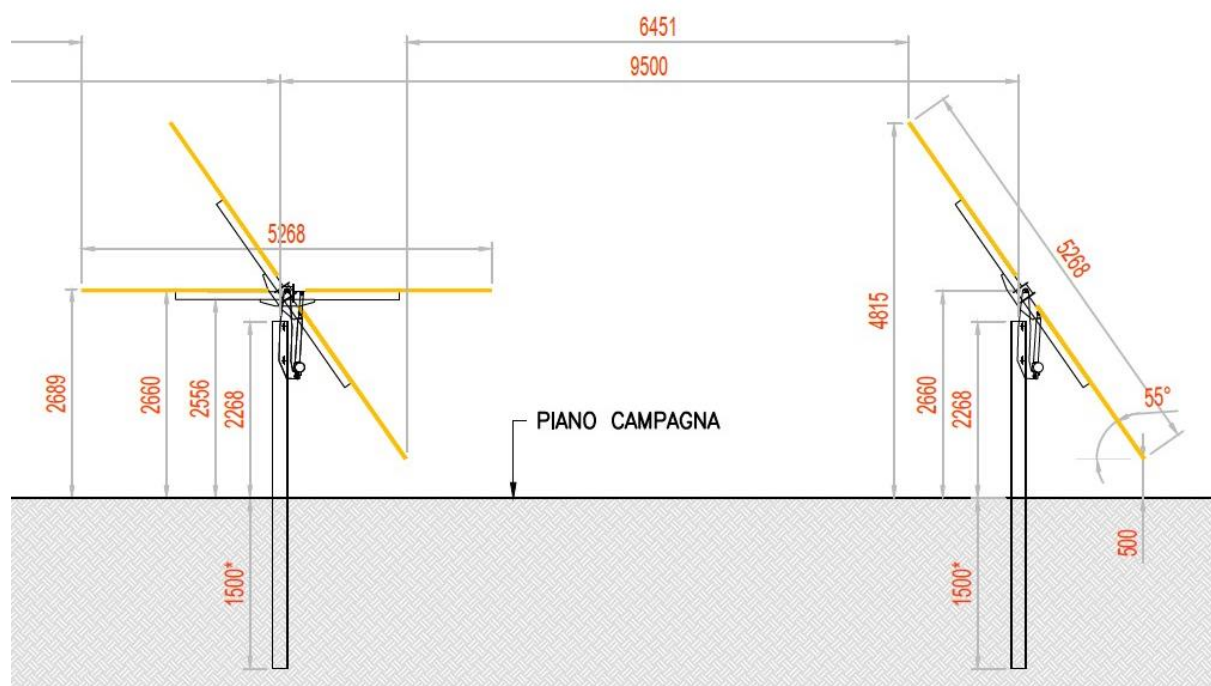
Particolare strutture di sostegno moduli, sezione trasversale.
